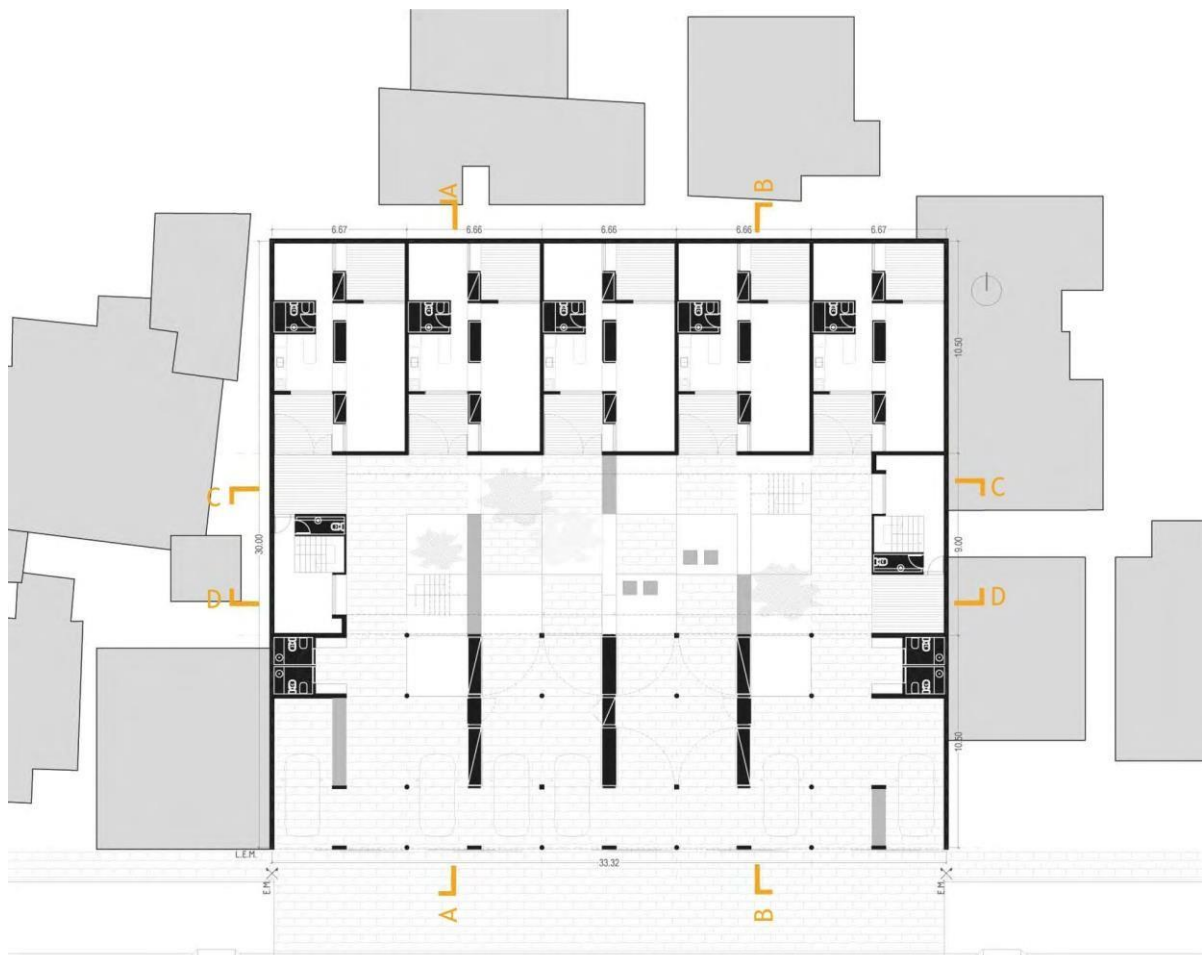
Planta nivel I. Tomada de: Arch Daily
